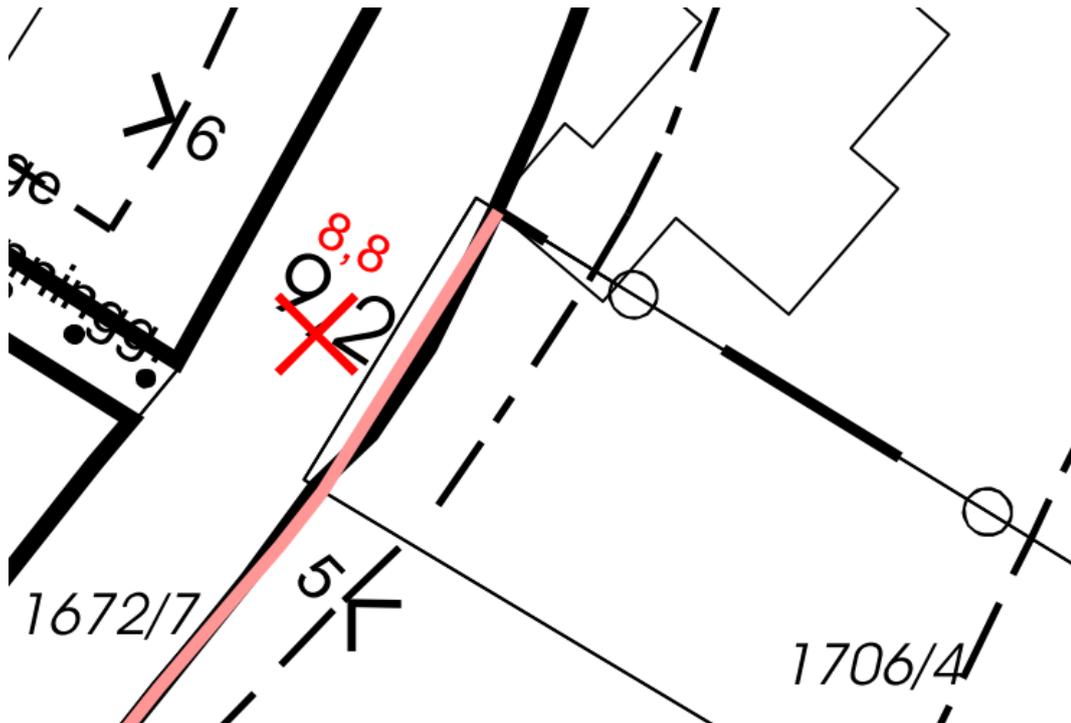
ÄP 18, Ausschnitt aus dem Vorabzug zum Auflageentwurf der Änderung 01/2024 des Bebauungsplans, ohne Maßstab
